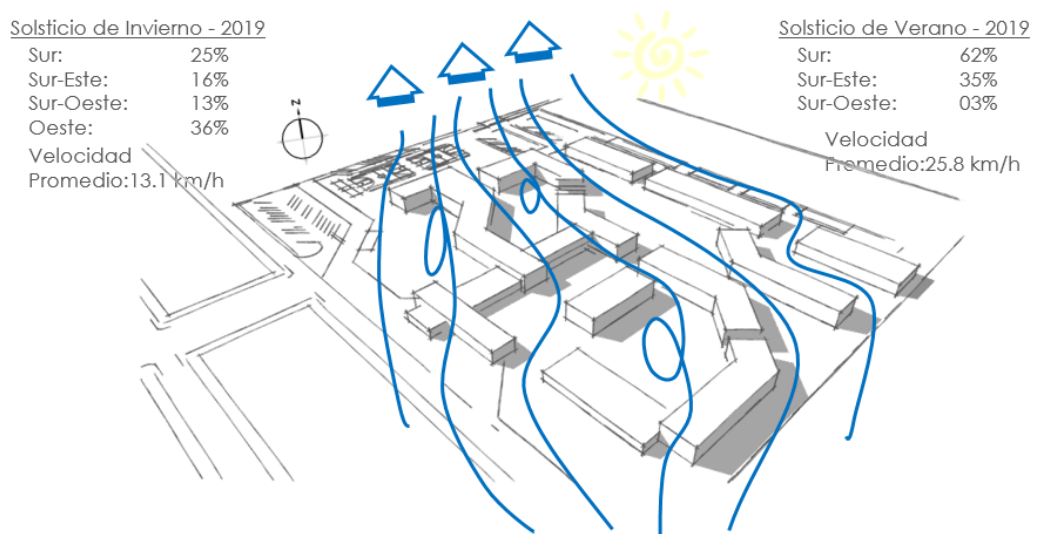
Plano de recorrido del viento – Fuente: Elaboración propia
